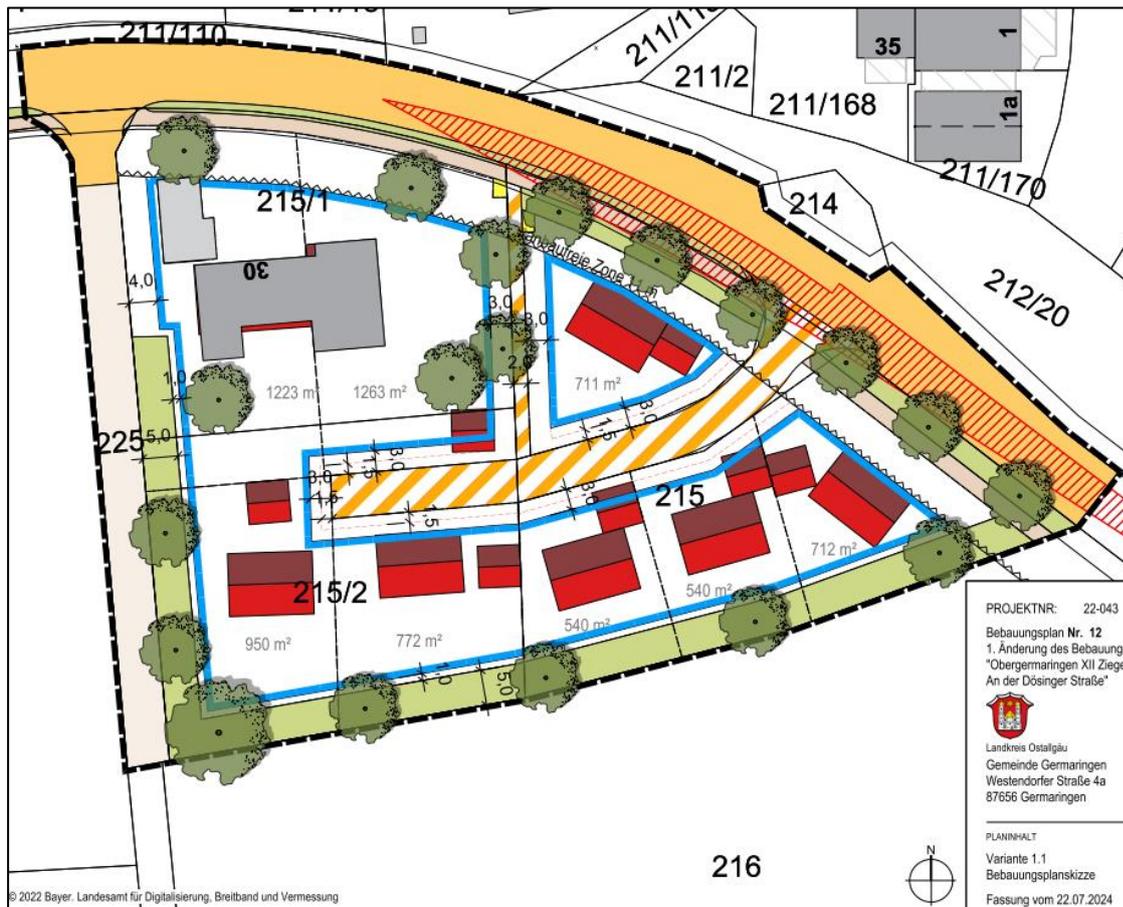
Entwurf Bebauungsplan, Stand Juli 2024 [13]
